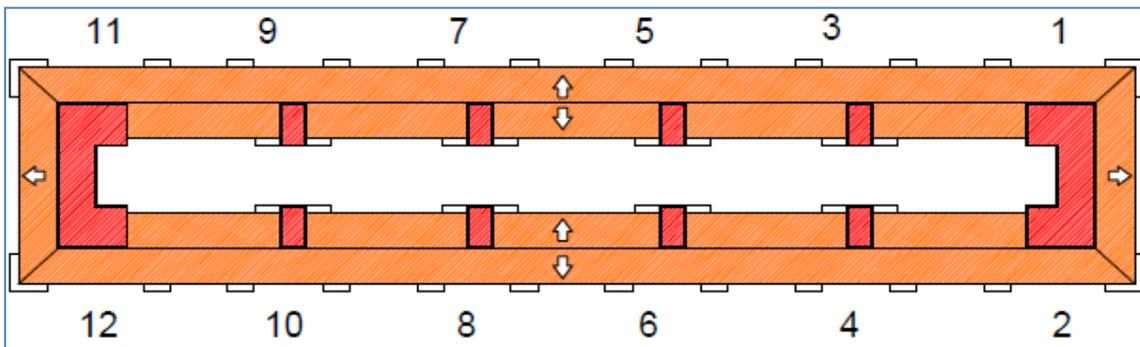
Imagen distribución de cubiertas por tipologías (naranja cubierta inclinada y roja cubierta plana transitable).
